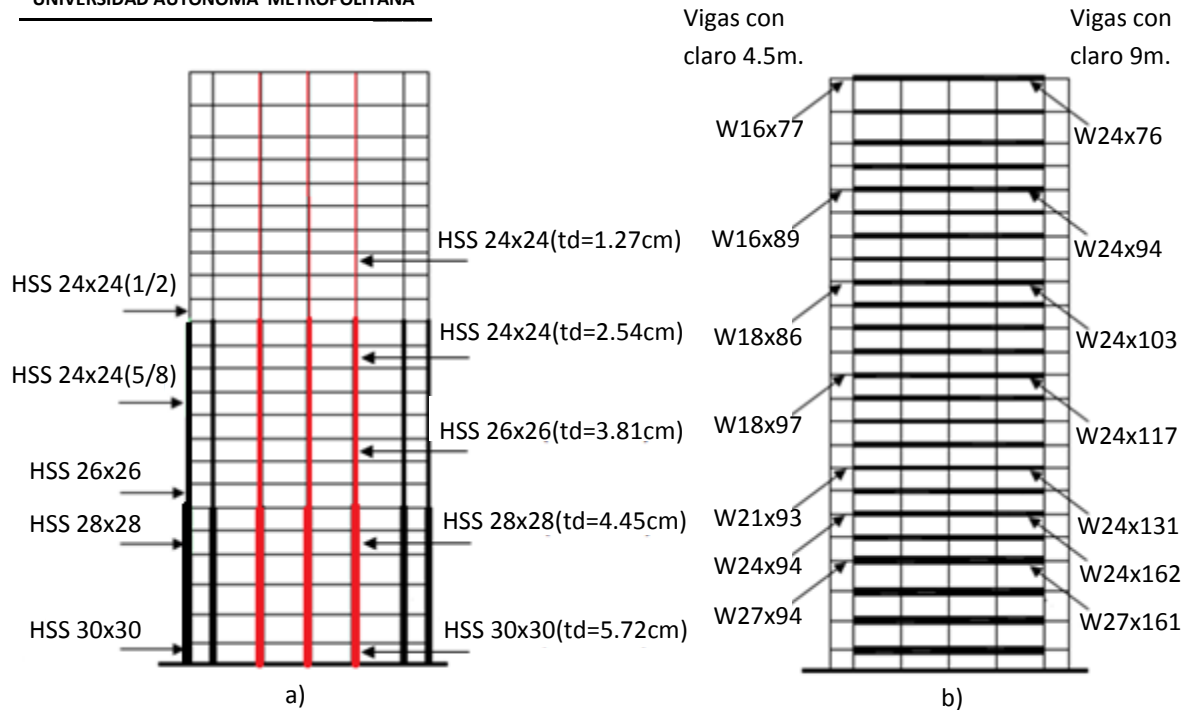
Perfiles en la edificación: a) Columnas y Columnas de soporte y b) Vigas.
